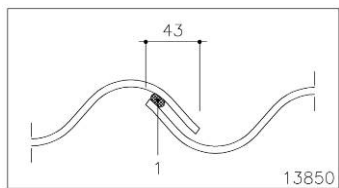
Cordon d'étanchéité dans le recouvrement transversal
